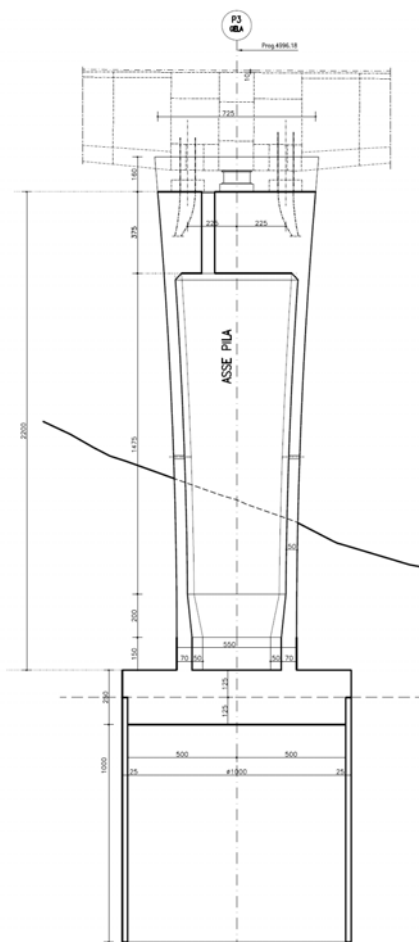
Sezione longitudinale della pila P3 pista per Gela
